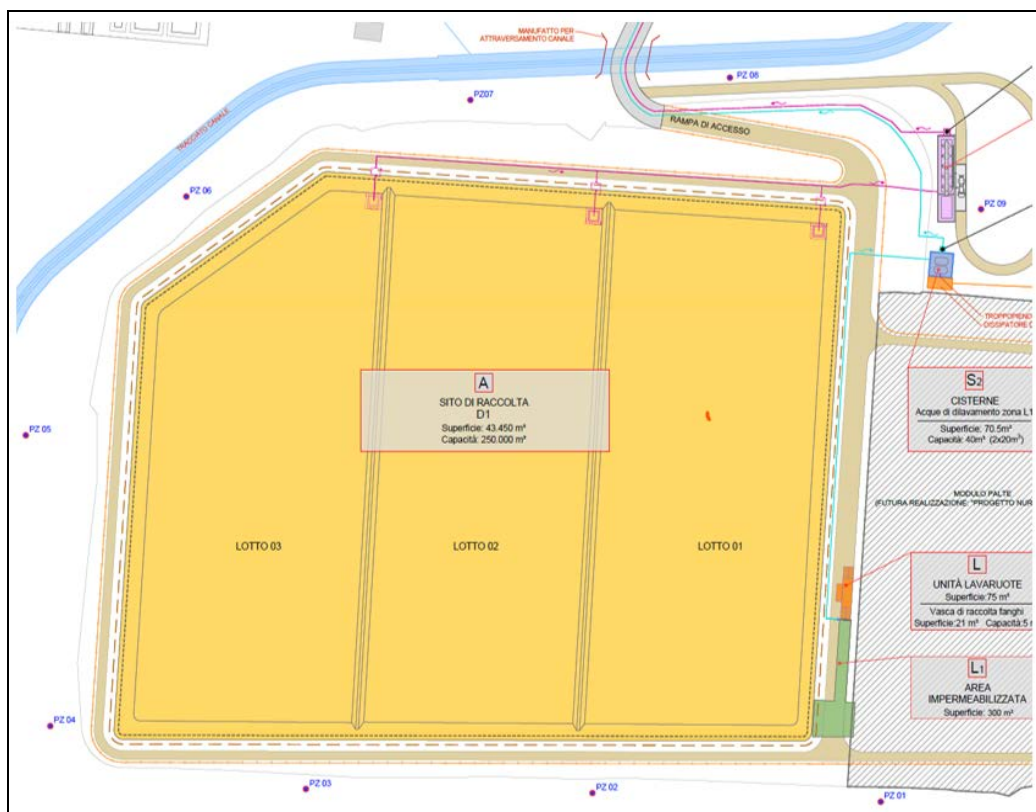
Planimetria SdR e posizione piezometri rete di monitoraggio
